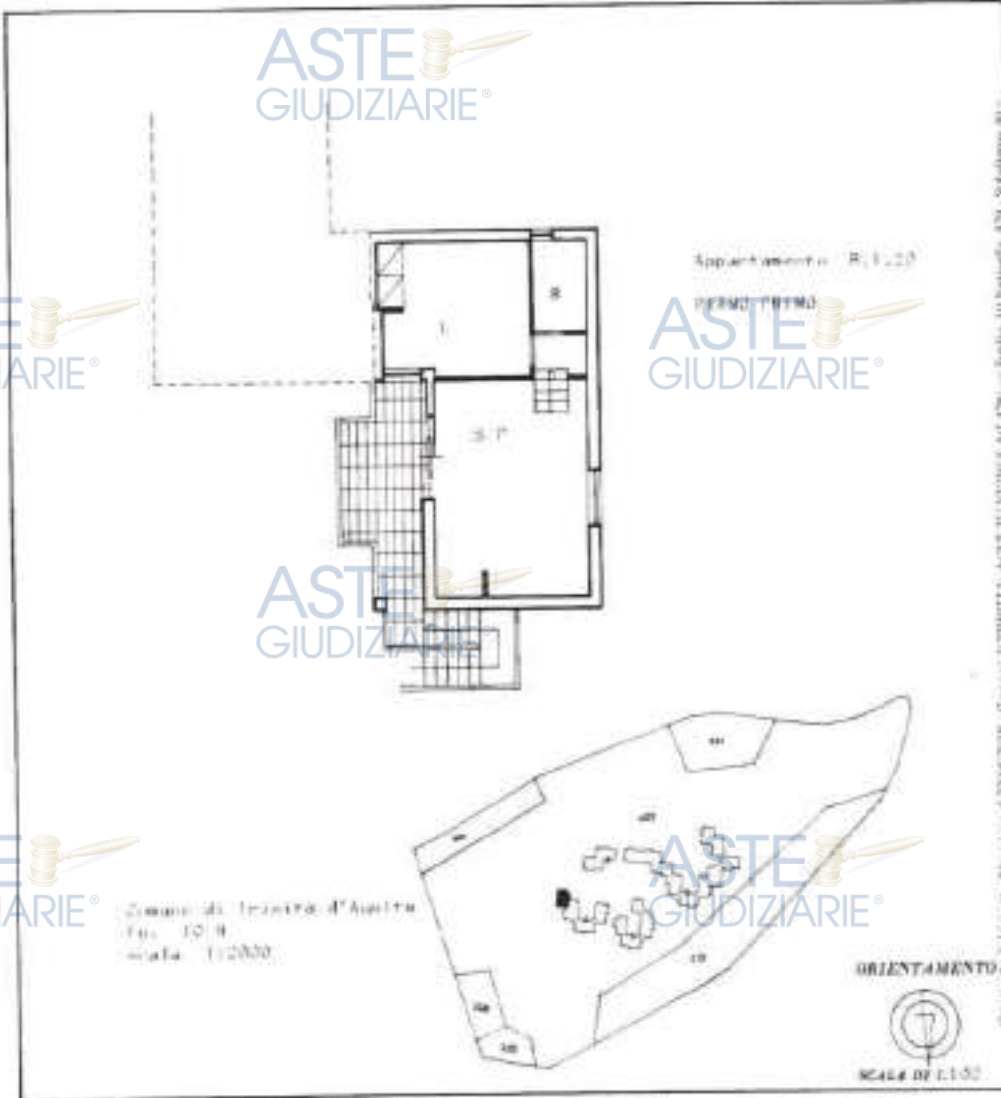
Visura planimetrica catastale aggiornata Fig. 10 Part. 429 Sub 39
